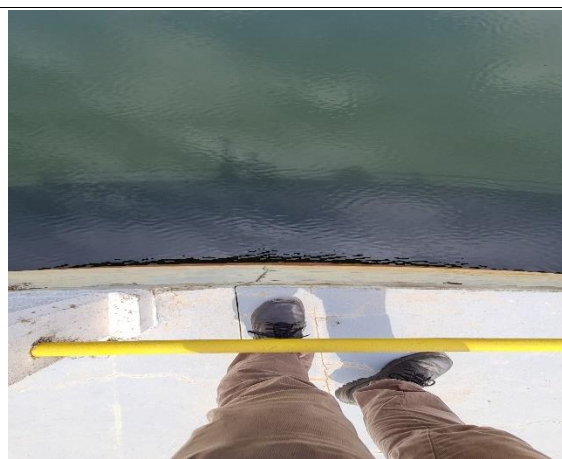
VISTA DA JUNTA DE DILATAÇÃO
